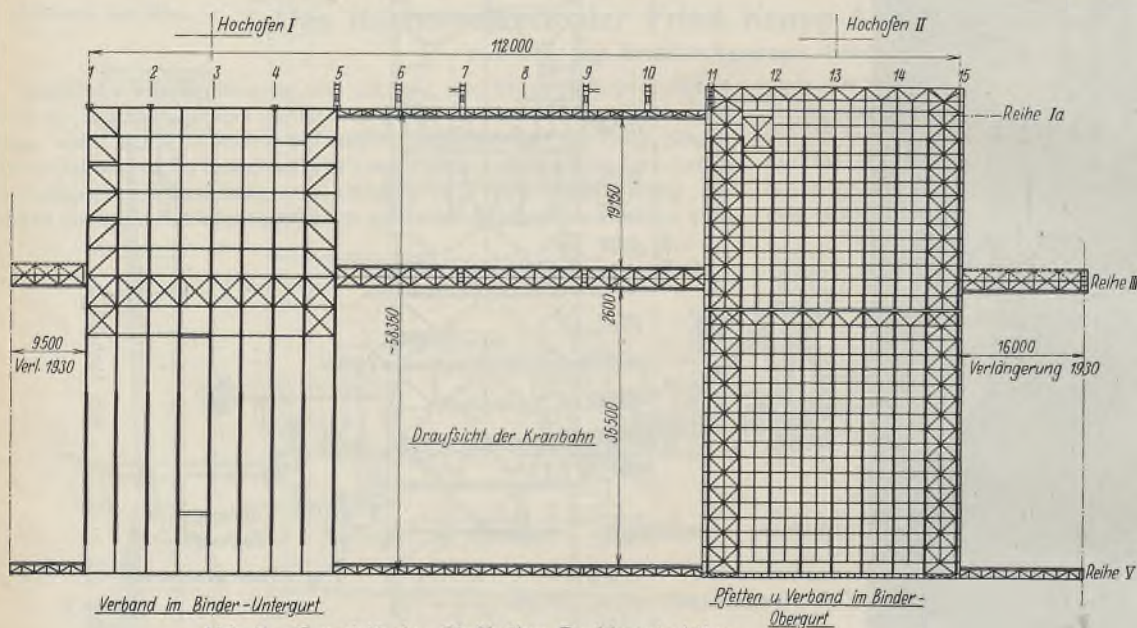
Grundriß der Gießhallen-Dachkonstruktion.
